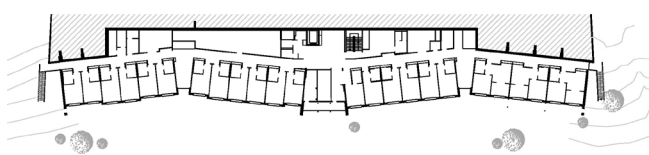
Der geknickte Grundriss des Anbaus ist ein bewusster, spielerischer Kontrast zur geraden Bestands-Onko-Reha und überspielt die große Gebäudelänge. Alle Patientenzimmer öffnen sich talseitig nach Süden.
